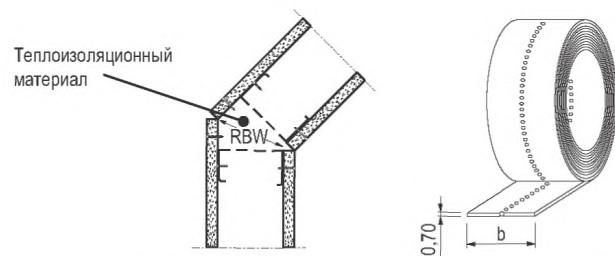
Соединение фрагментов каркаса стены под произвольным углом
